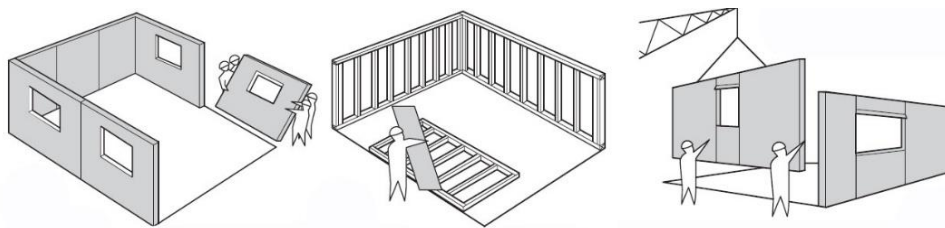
Métodos de construção: painéis parciais pré-fabricados, reticulados montados em obra, e painéis de grande dimensão pré-fabricados (TRADA, 2008).
